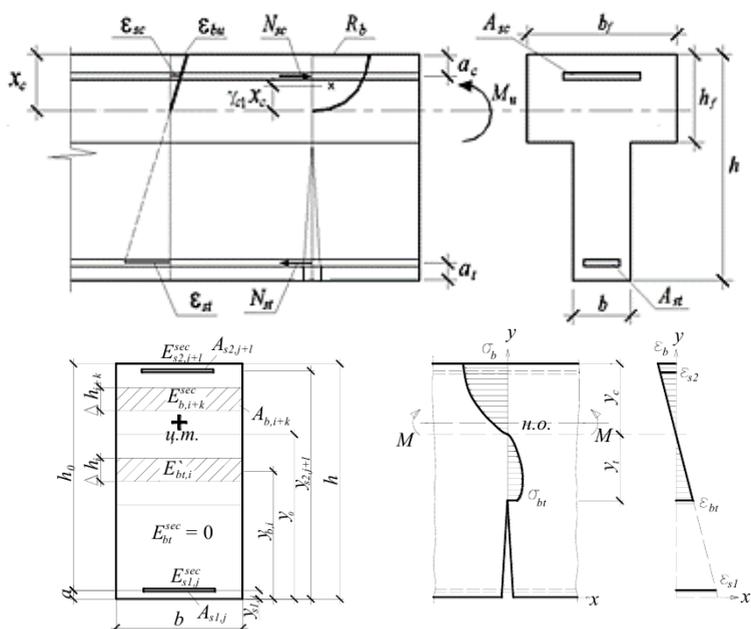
Расчетная схема нормального сечения изгибаемого железобетонного элемента до и после образования трещины
